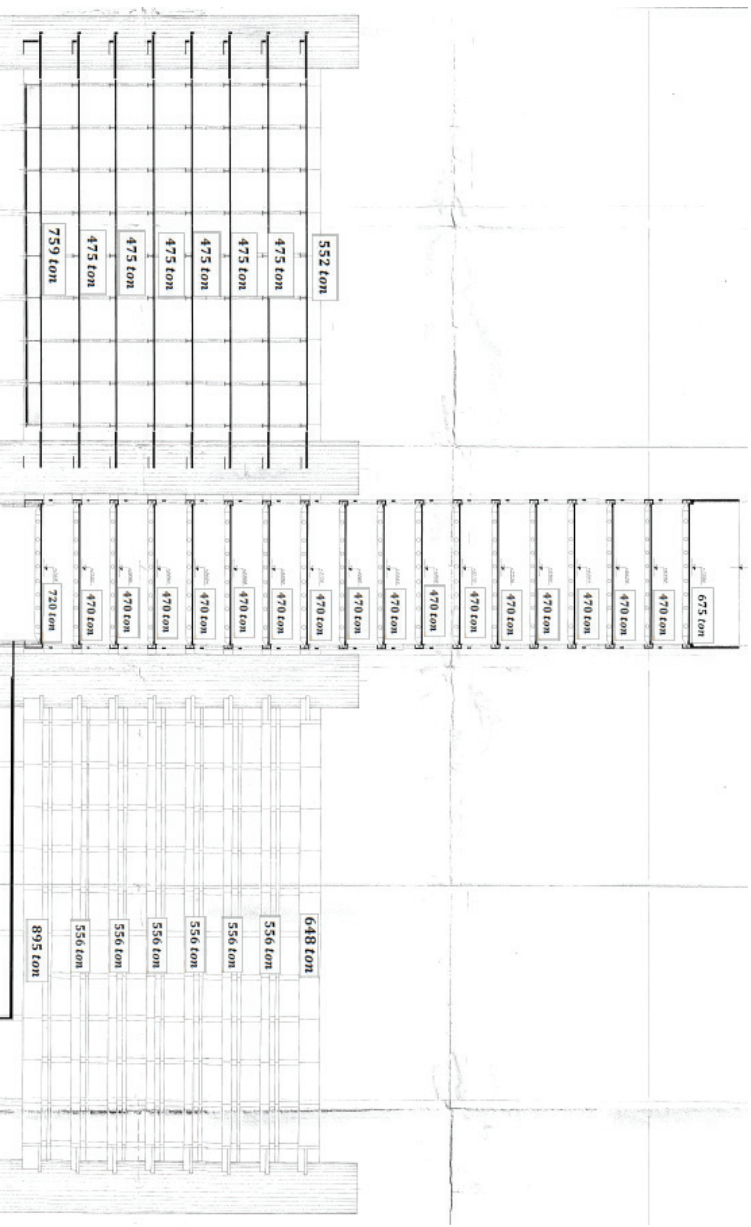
Sezione parziale e vista posteriore della torre con distribuzione delle masse sismiche ai piani
